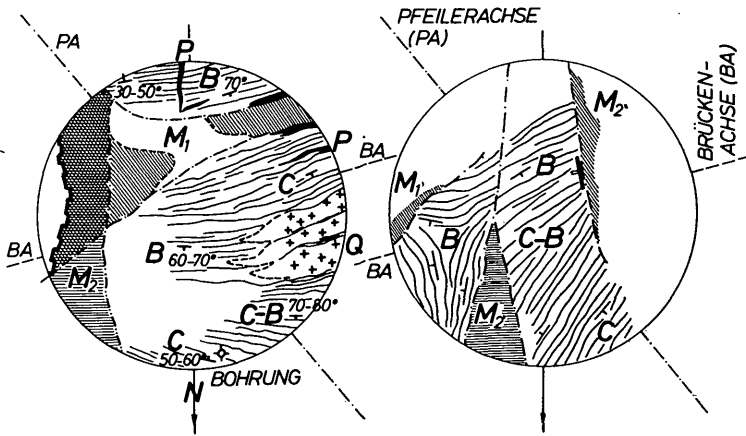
Grundriß des linken und rechten Pfeilerfundamentes. Der Durchmesser beträgt 11.46 m. Die Signaturen werden im Text erläutert.
